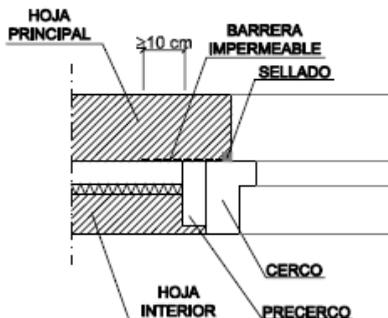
Ejemplo de encuentro de la fachada con la carpintería
